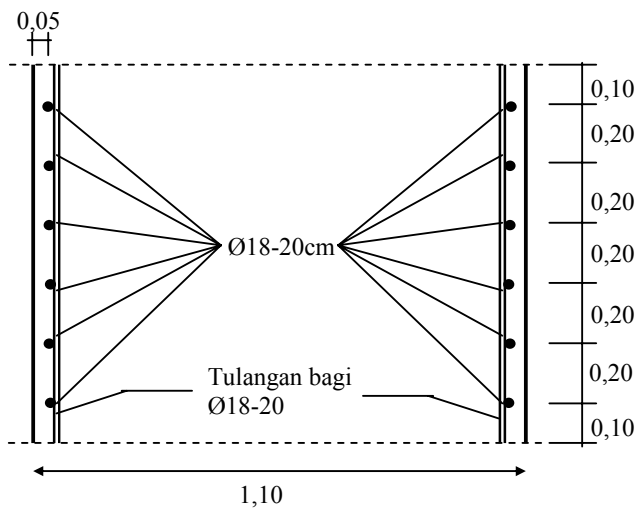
Penulangan Slab Beton Pondasi Bangunan Pengambilan
